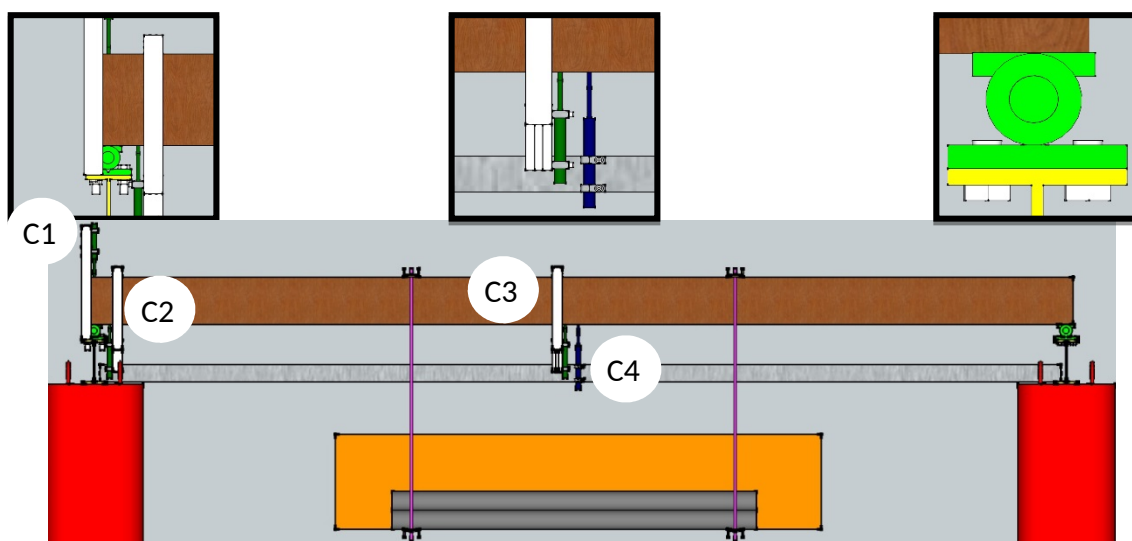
2Schéma de détails d'une poutre montée sur le montage banc d'essai
